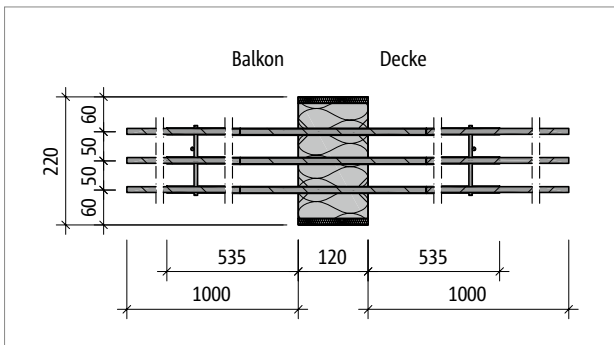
Schöck Isokorb® XT Typ B: Produktgrundriss
